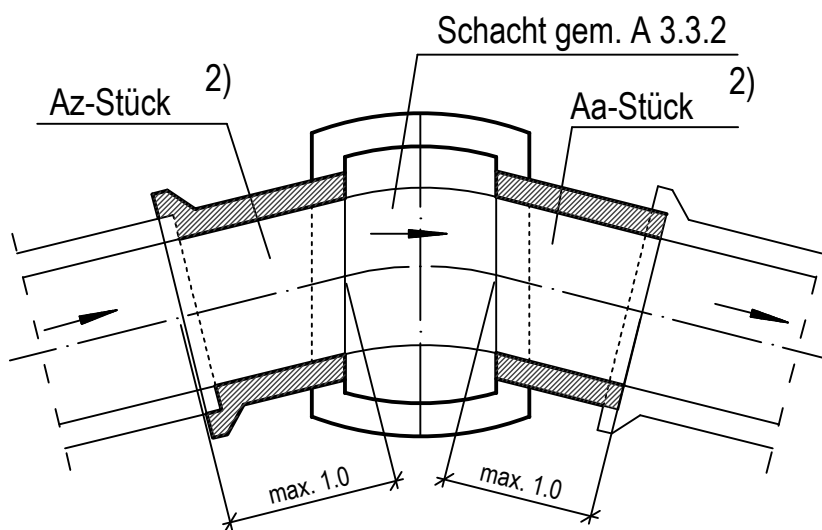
Beton - oder Stahlbetonrohre DN 700 bis DN 1500
